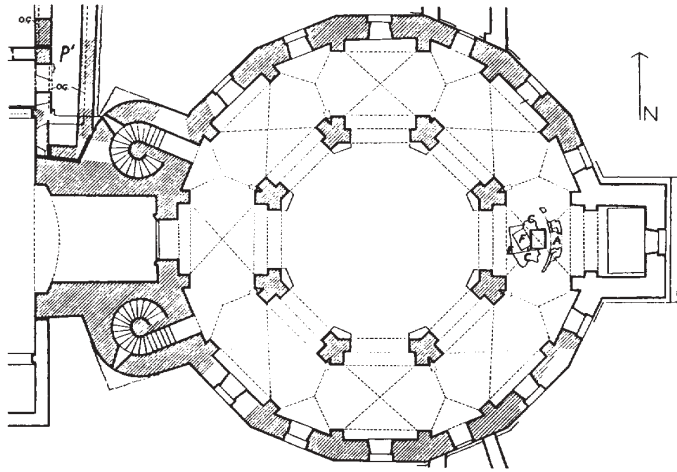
Aachen, Pfalzkirche St. Maria, Grundrißrekonstruktion.
